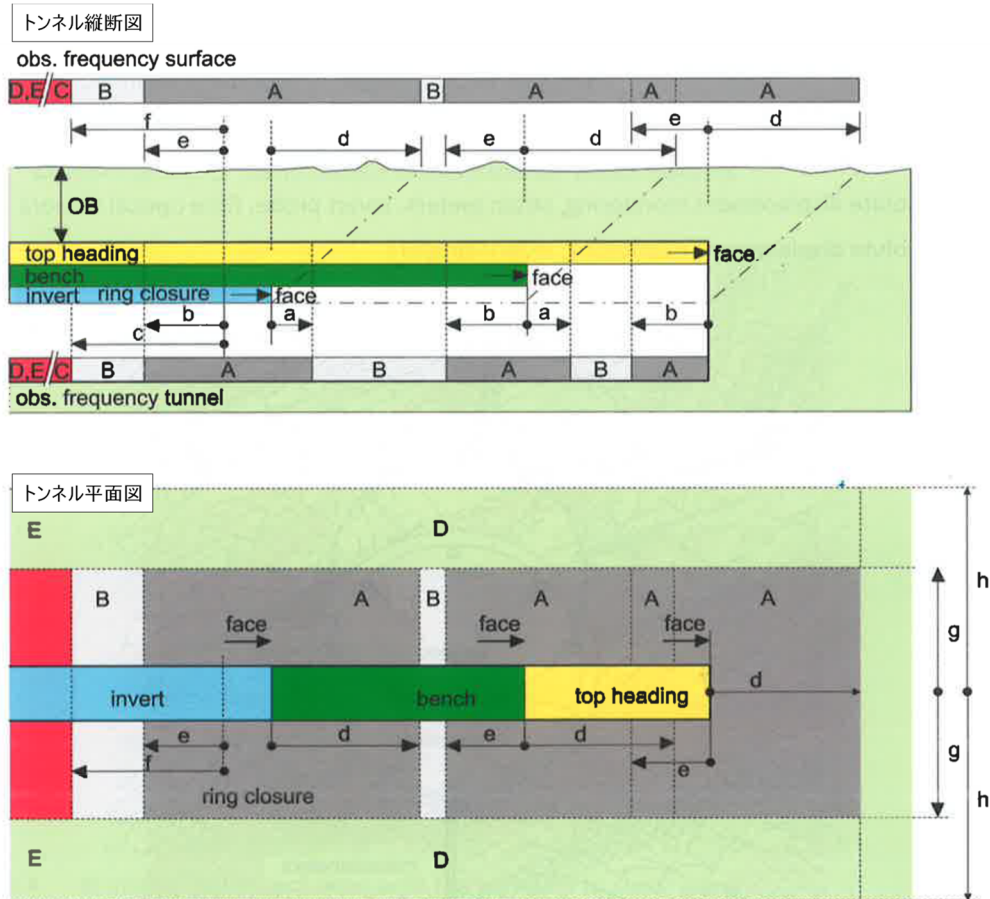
推奨計測頻度をとる切羽と計測断面の位置関係 上：縦断面図、下：地表面平面図 [56]
